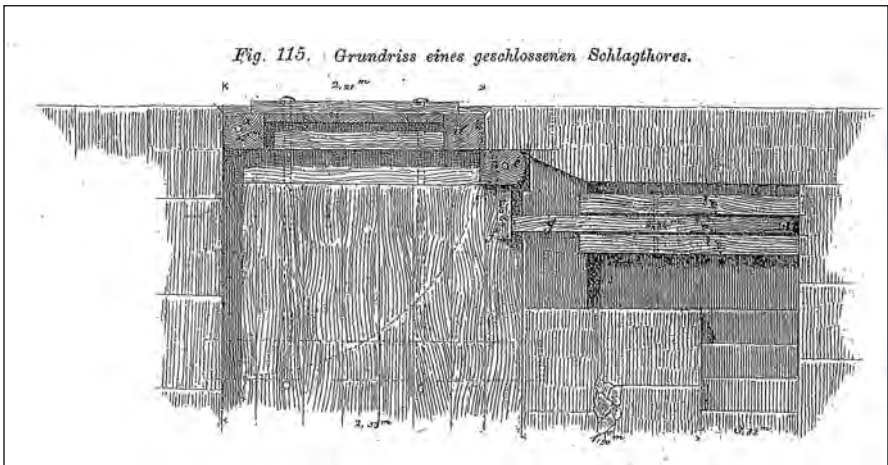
Schlagtor, Grundriss (Förster 1885, Tafel XXI).
